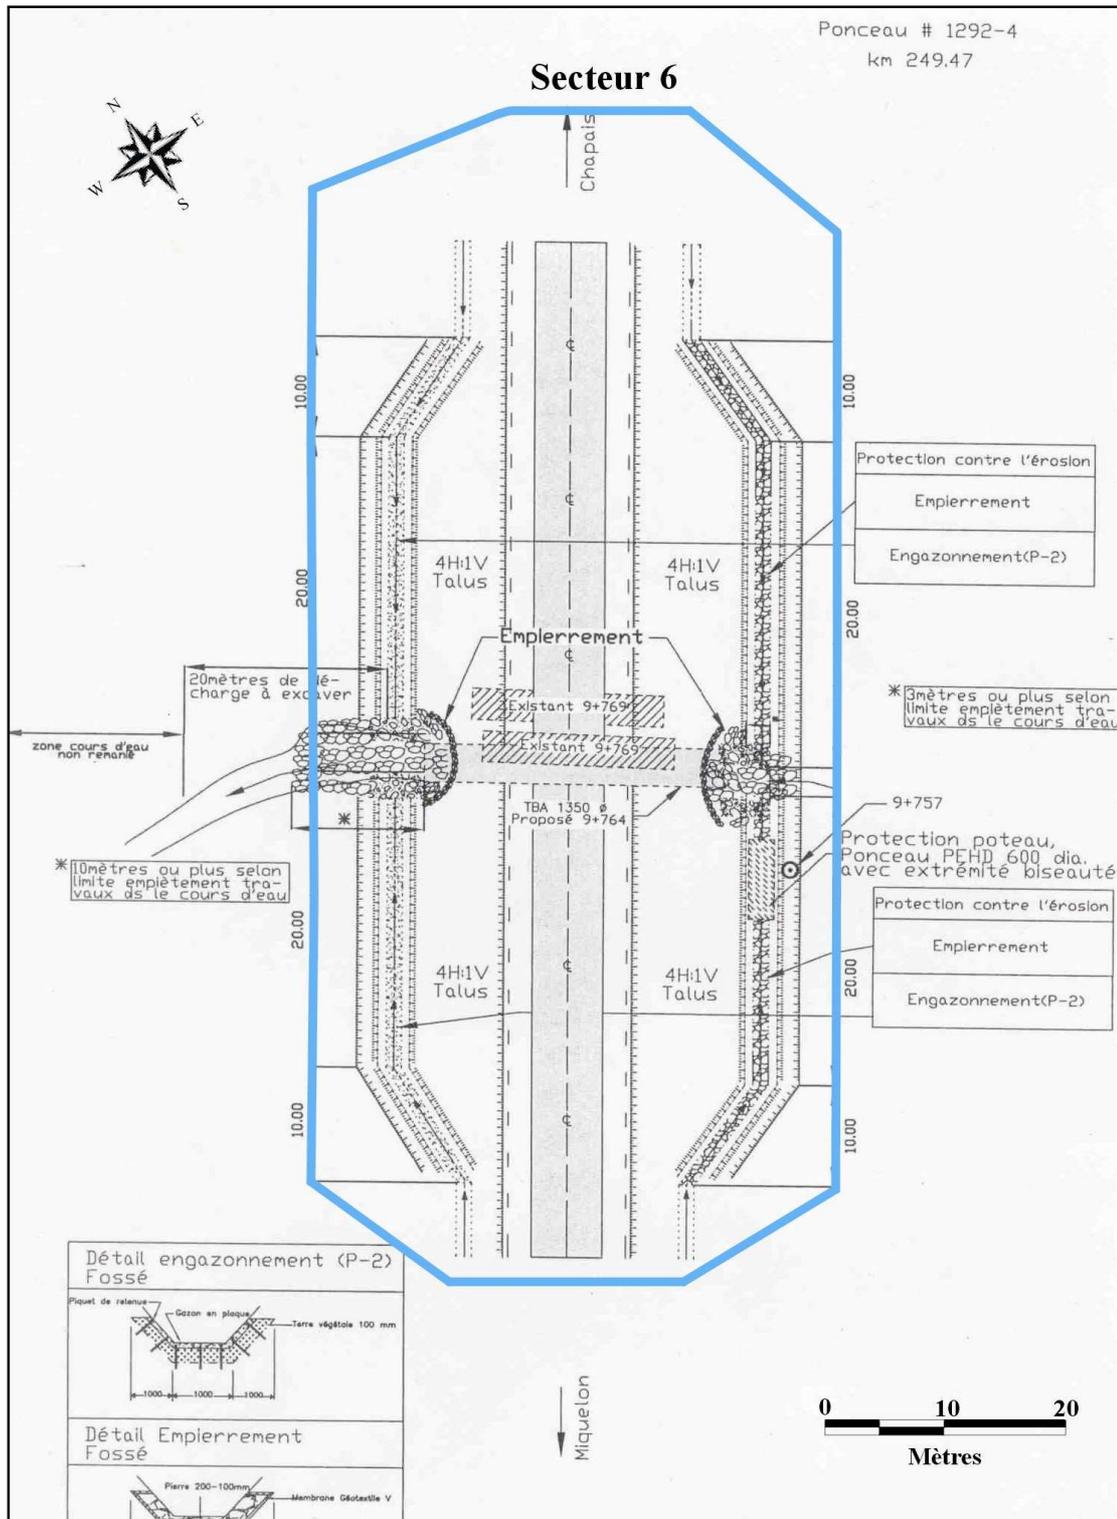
projet 154-07-0858, ponceau #1292-4, plan de construction et secteur d'inventaire.
